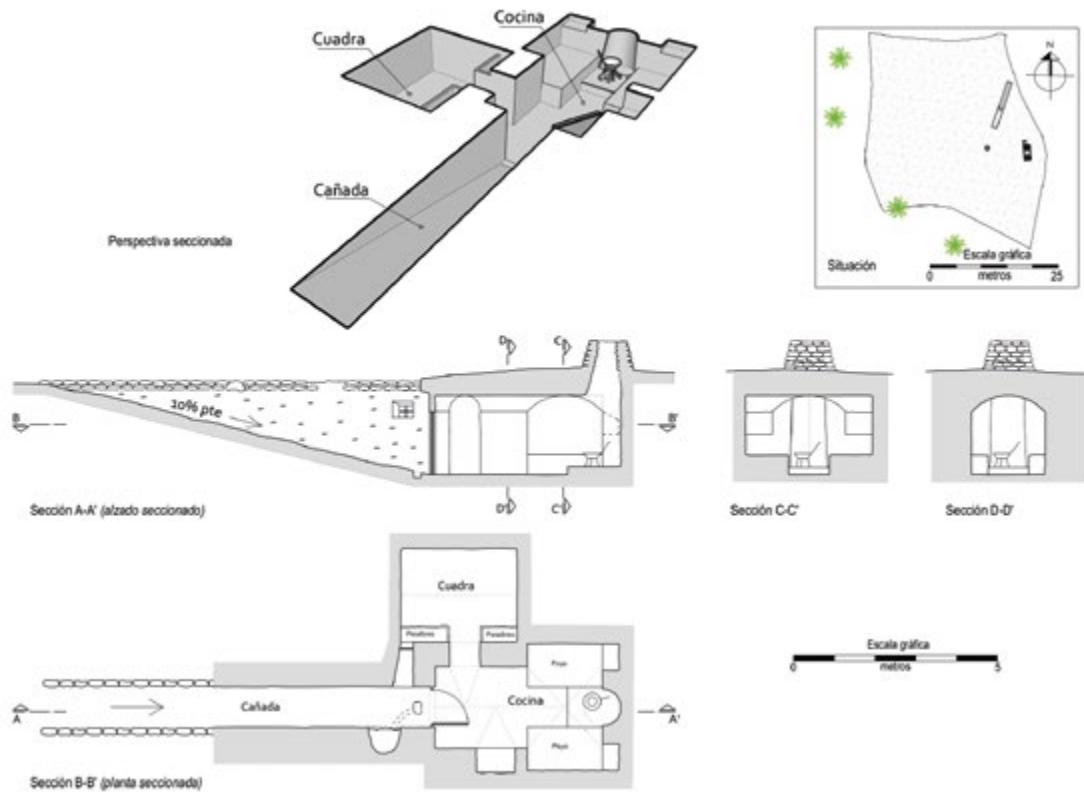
Perspectiva seccionada, planta, secciones transversales y longitudinal de la cueva del Erizo, Daimiel
